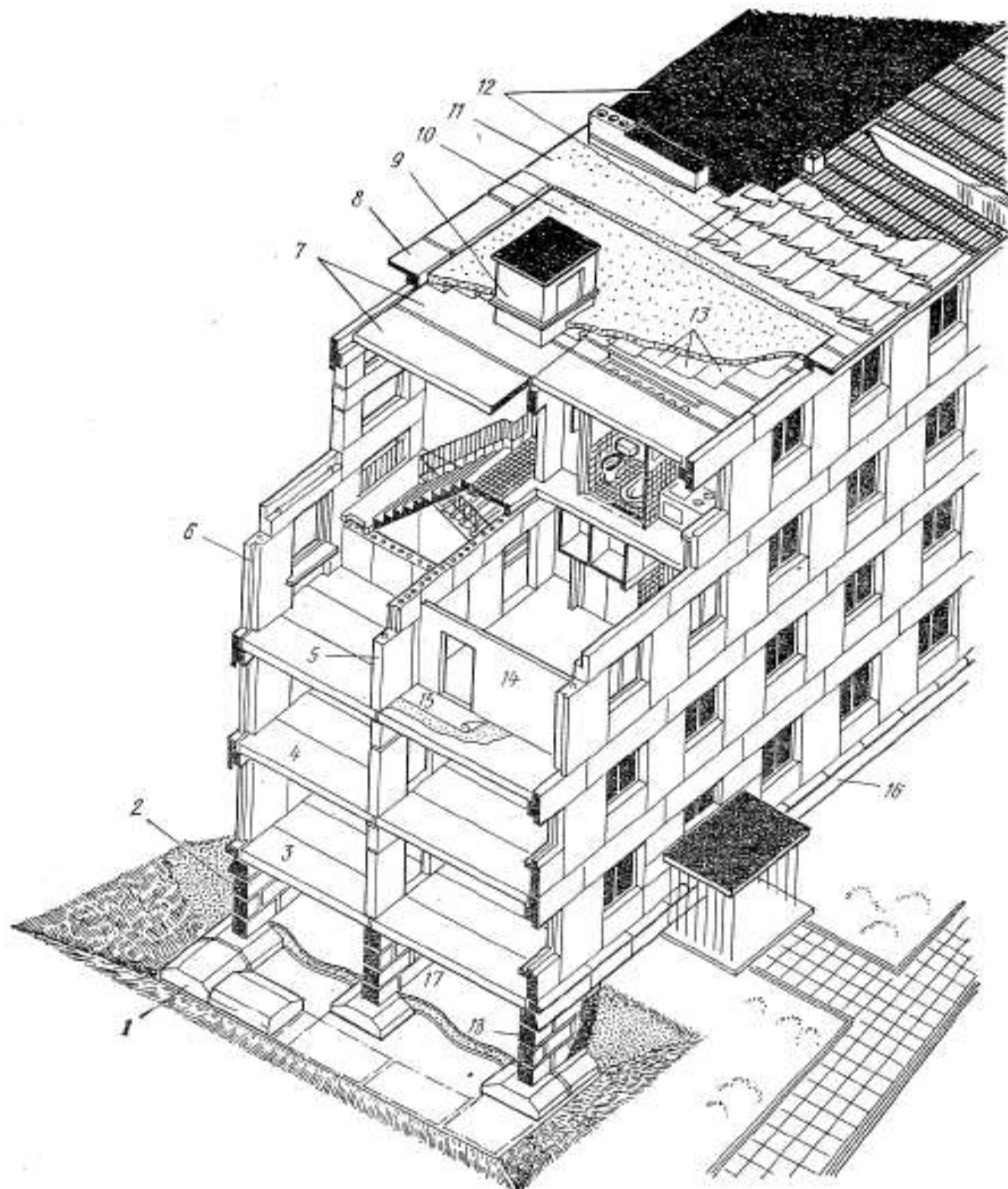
Крупноблоковий житловий будинок: 1 – фундаментна плита; 2 – стіновий фундаментний блок; 3 – перекриття над під-валом; 4 – міжповерхове перекриття; 5 – внутрішня несуча поздовжня стіна; 6 – те саме, зовнішня; 7 – плити покриття; 8 – карнизна плита; 9 – вихід на покриття; 10 – утеплювач; 11 – цементно-піщана стяжка; 12 – суміщене покриття; 13 – пароізоляція; 14 – перегородка; 15 – підлога з лінолеуму; 16 – цоколь; 17 – підлога підвалу; 18 – стіна підвалу
